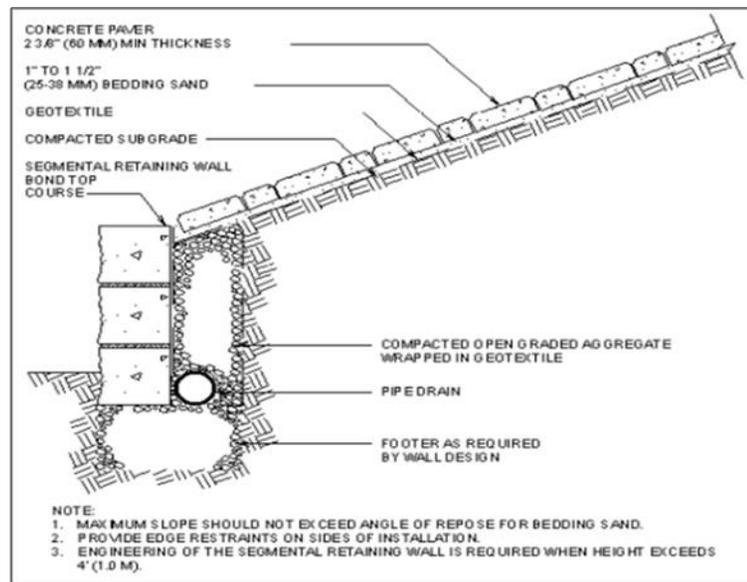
Consideraciones de Drenaje en Pavimentos Articulados Fuente: (Uni-Group USA, 2010).
